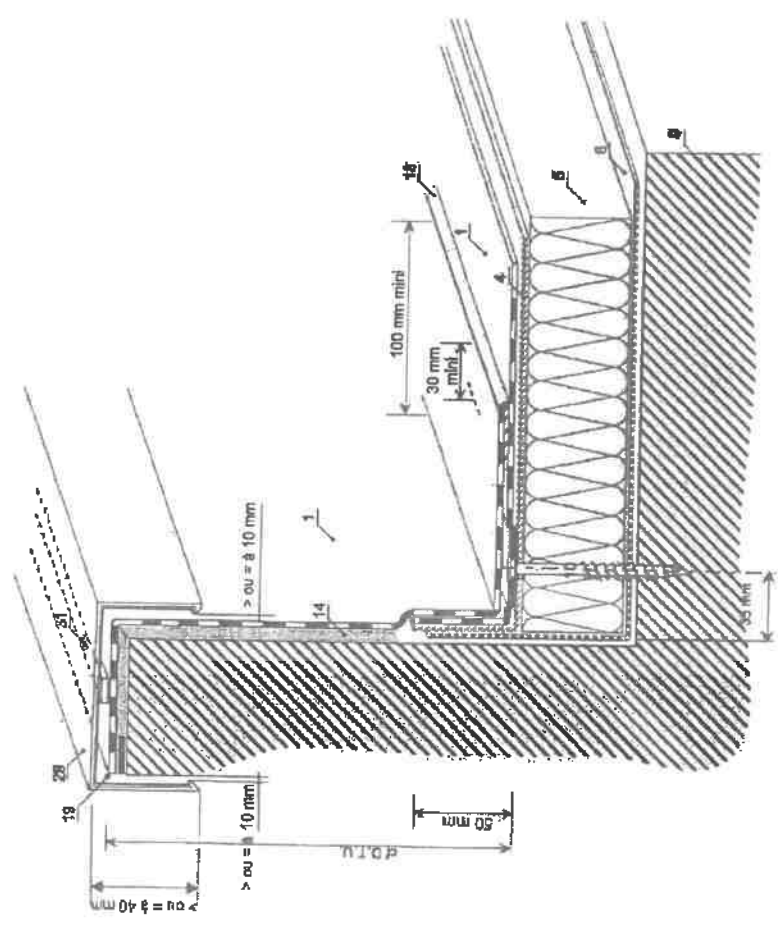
Relevé d'étanchéité - Coupe de principe sur béton travaux neufs
